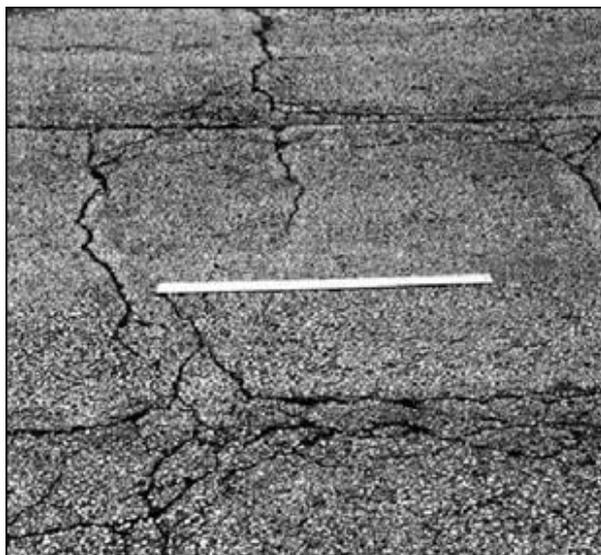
Fisuras en Bloque – Baja Severidad
